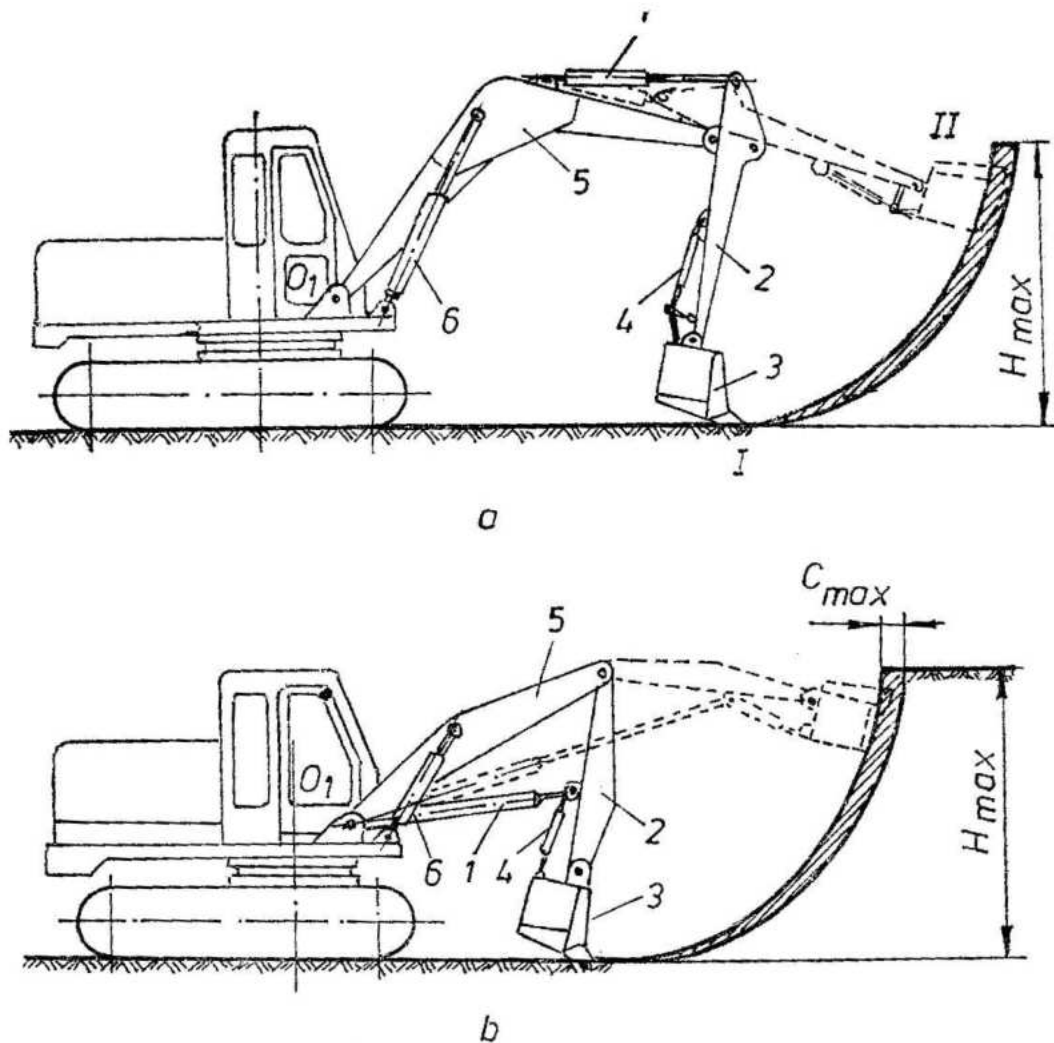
Excavatoare hidraulice cu lingură dreaptă
